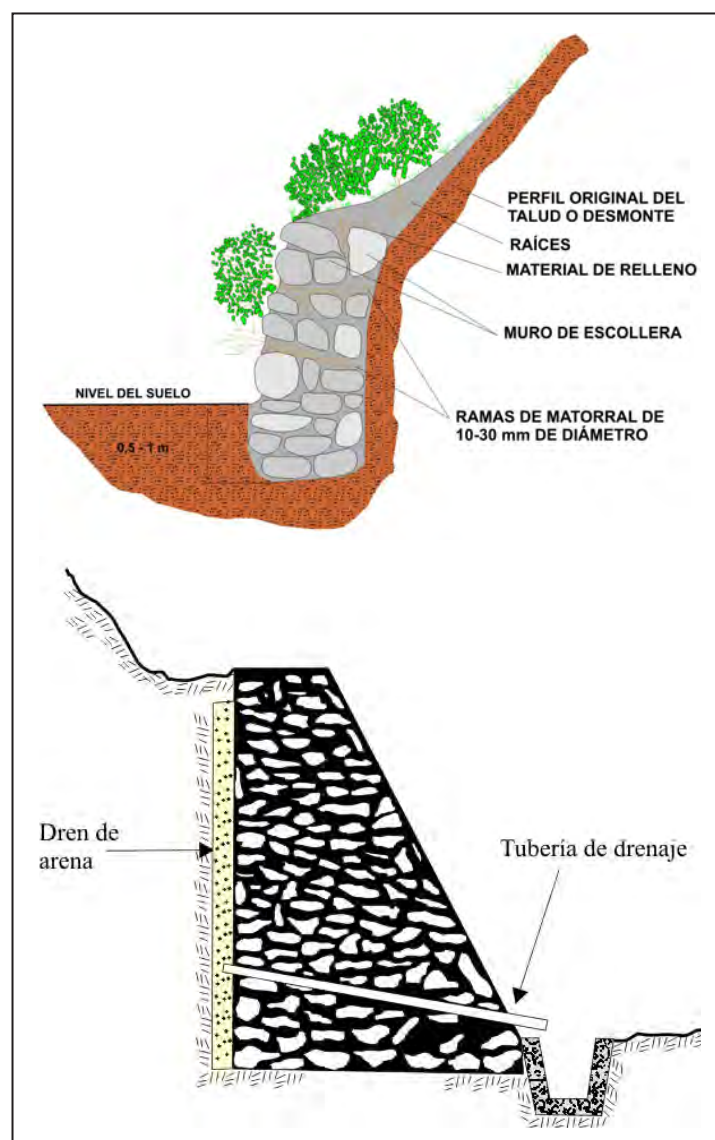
a) muros de gravedad de piedra seca. b) muros de gravedad de piedra argamasada.
